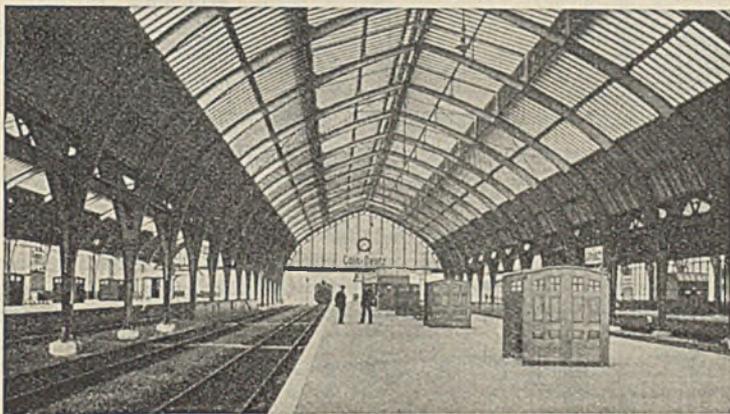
Bahnhofshalle Cöln-Deutz. Innenansicht.
